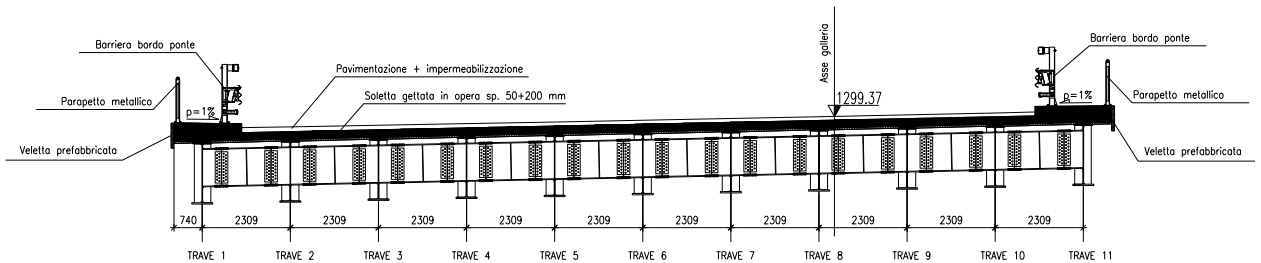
Sezione trasversale tipica del ponte di accesso alla galleria
